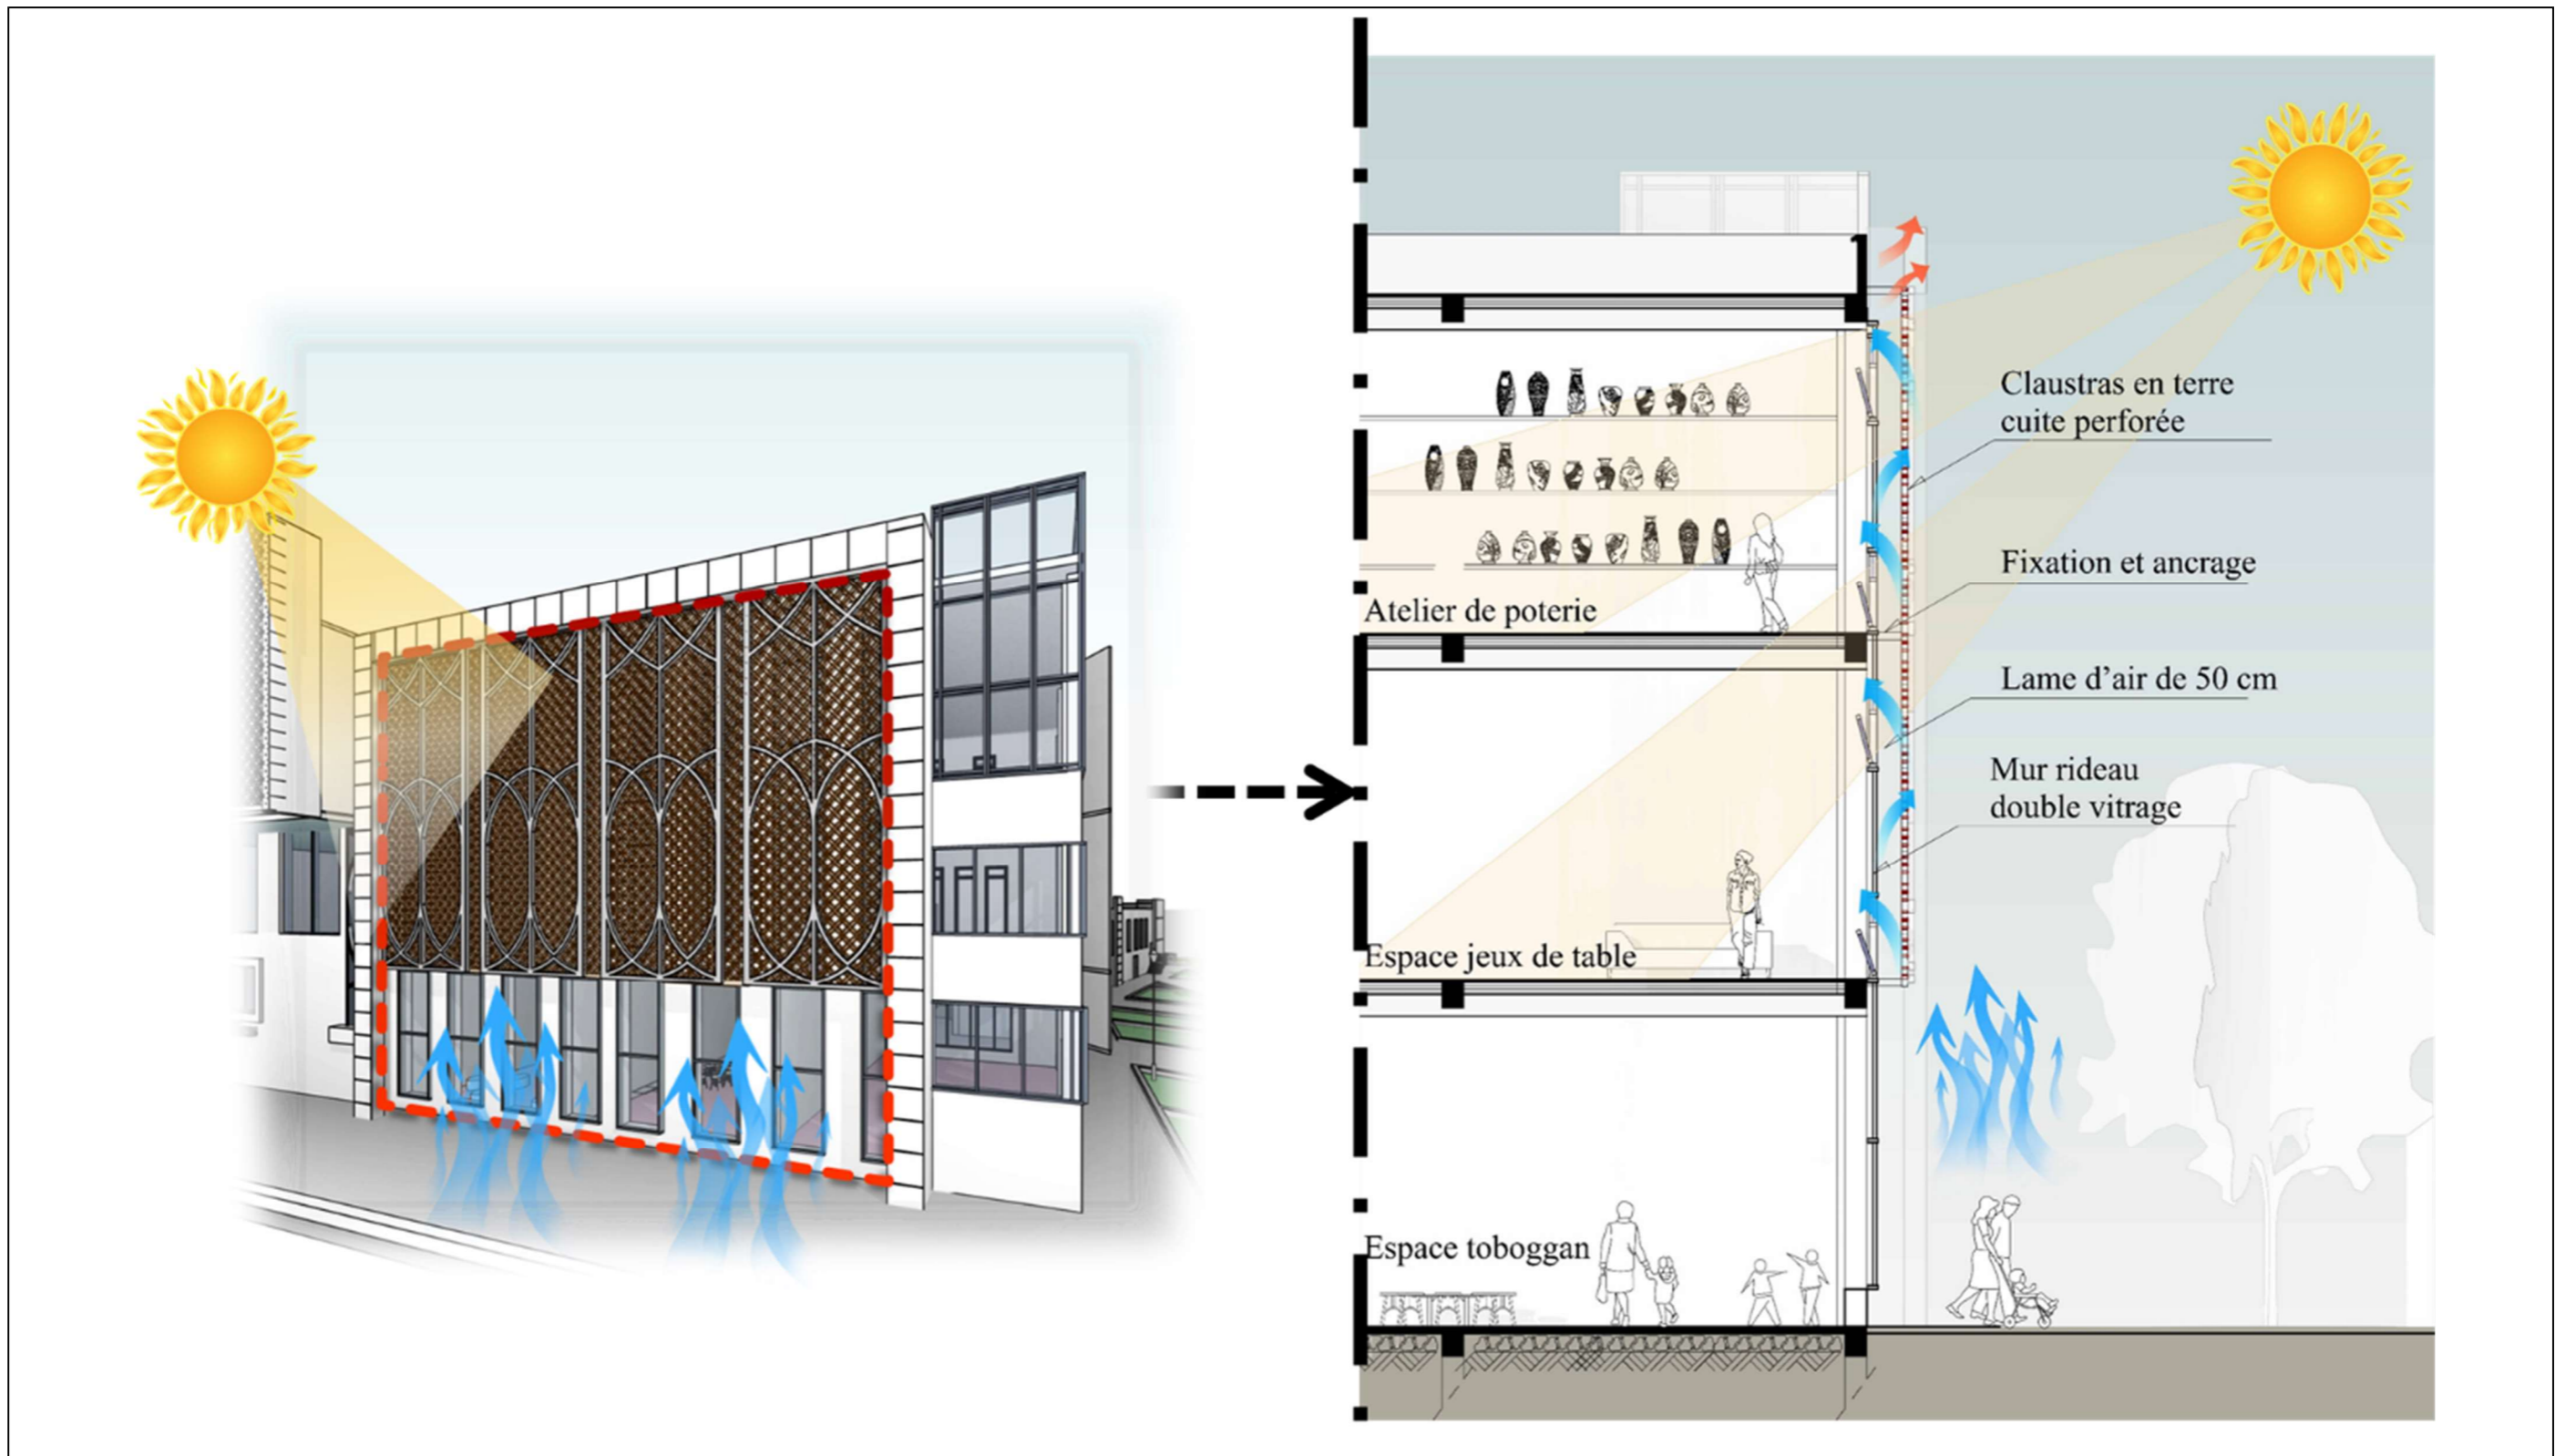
SCHEMA FAÇADE DOUBLE PEAU
